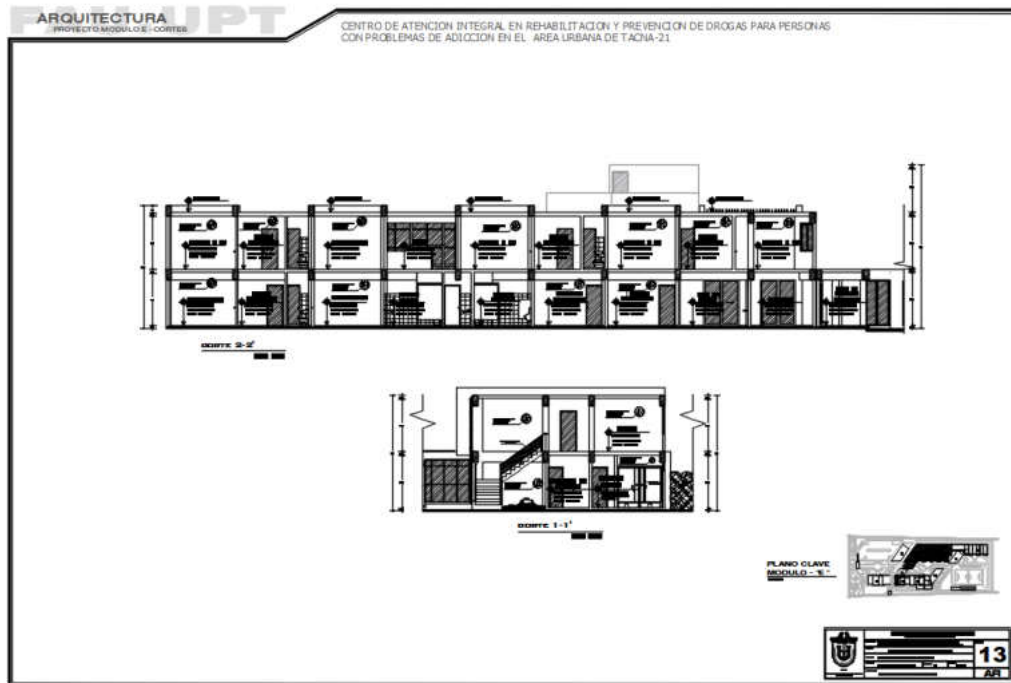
Plano cortes bloque E, fuente elaboración propia.
